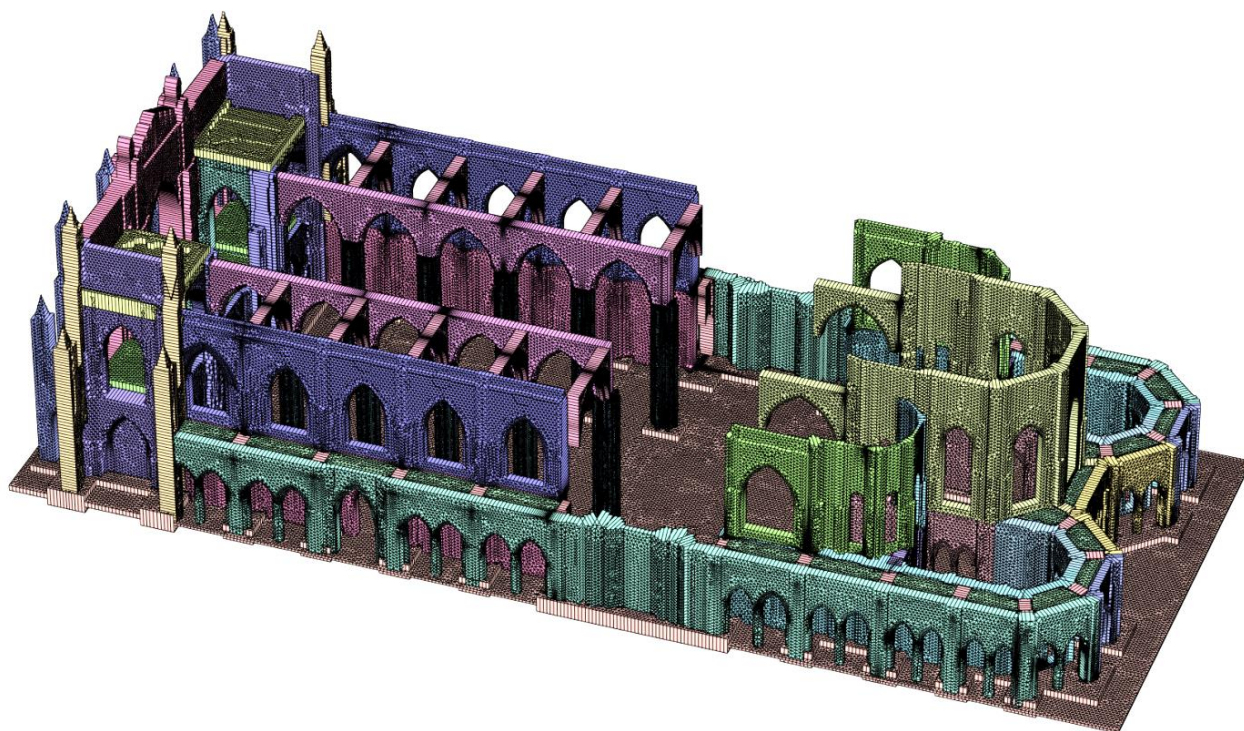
Modelo estructural tridimensional del proyecto en software SAP2000.
